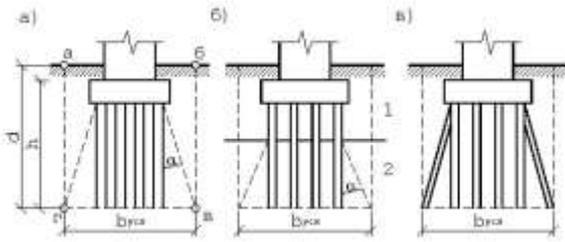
Схемы условных фундаментов для расчета по второй группе предельных состояний
